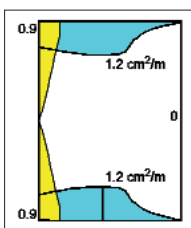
Horizontalbewehrung im Einspannbereich, Einwirkung $F_{Ed,x} = 1 \text{ MN}$
